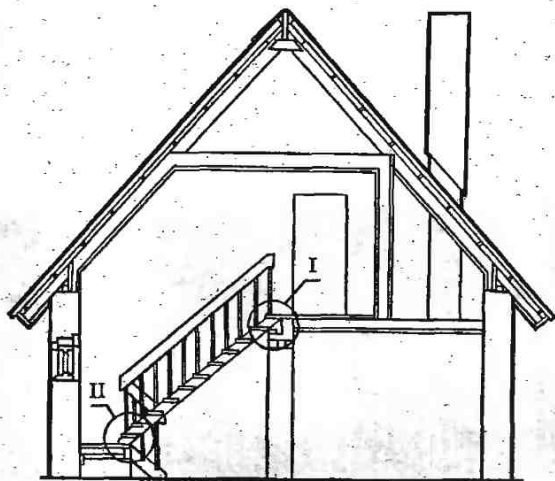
Общий вид и конструктивные элементы двухмаршевой внутренней лестницы: 1 — доски пола; 2 — тетива; 3 — опорный брус; 4 — проступь; 5 — стяжной болт; 6 — балка площадки
